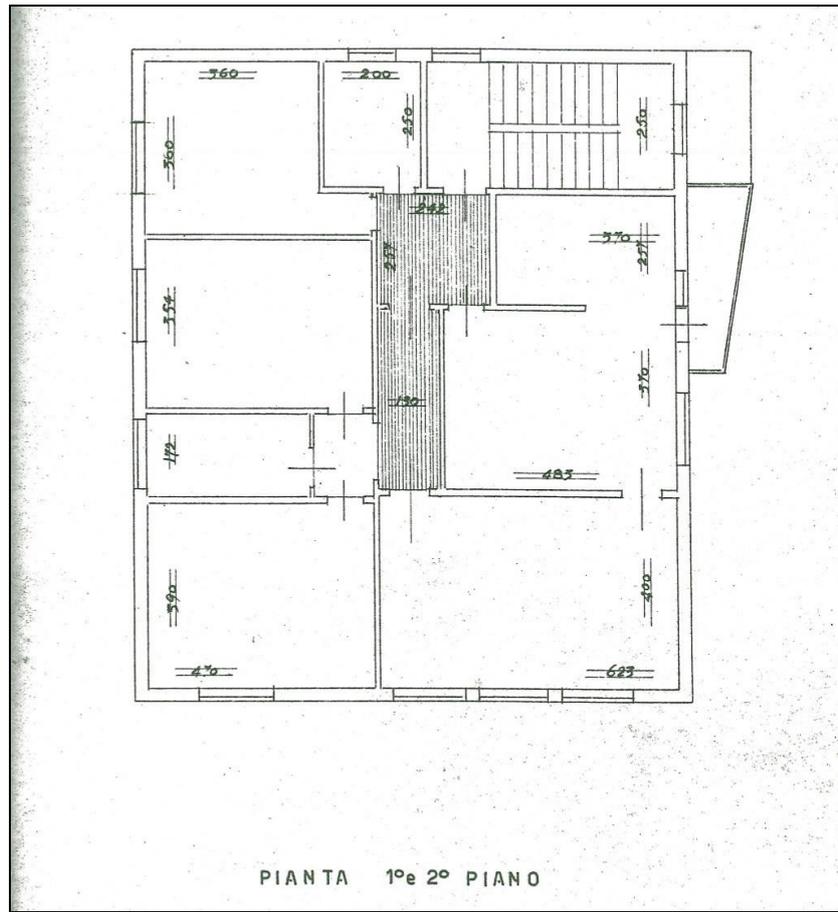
a. Stato approvato: Pianta Autorizzazione Edilizia del 05.07.1954.
